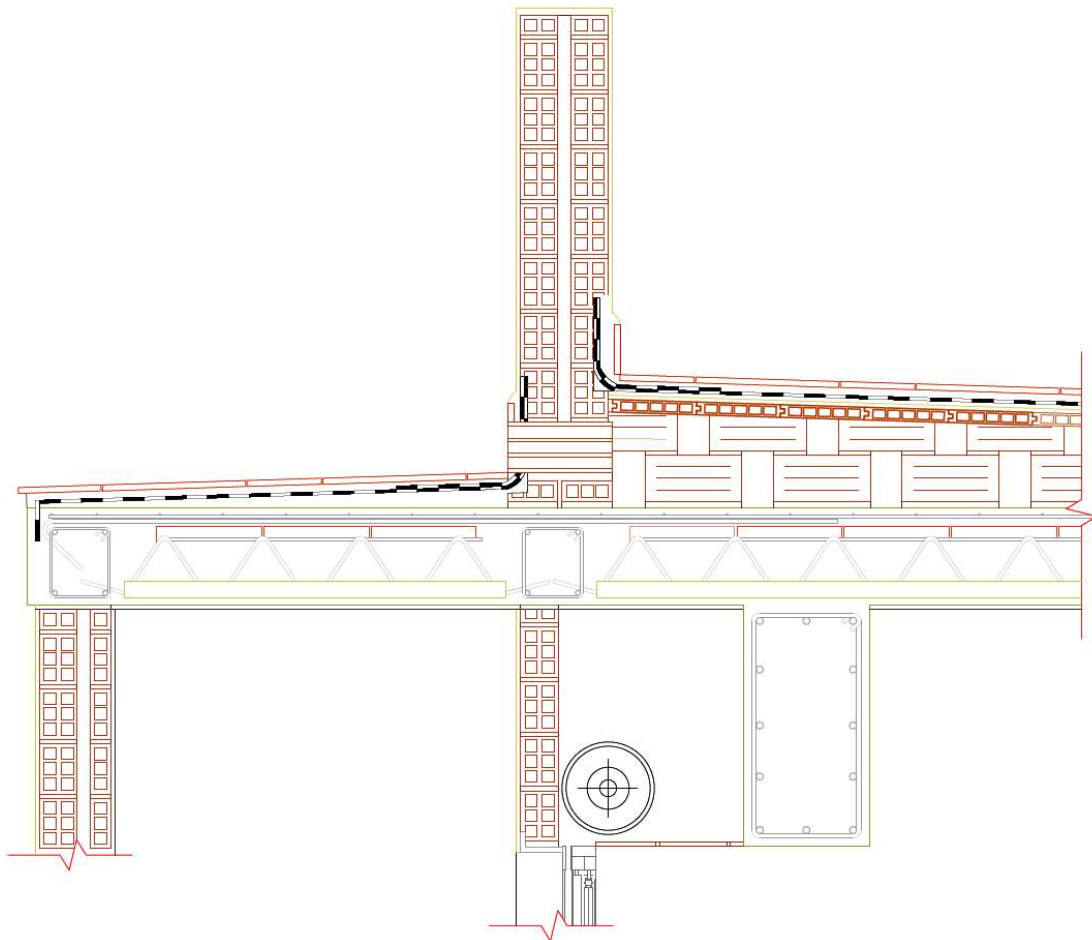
Detalle cubiertas actuales, (Fuente: autor) * ver plano nº 8
